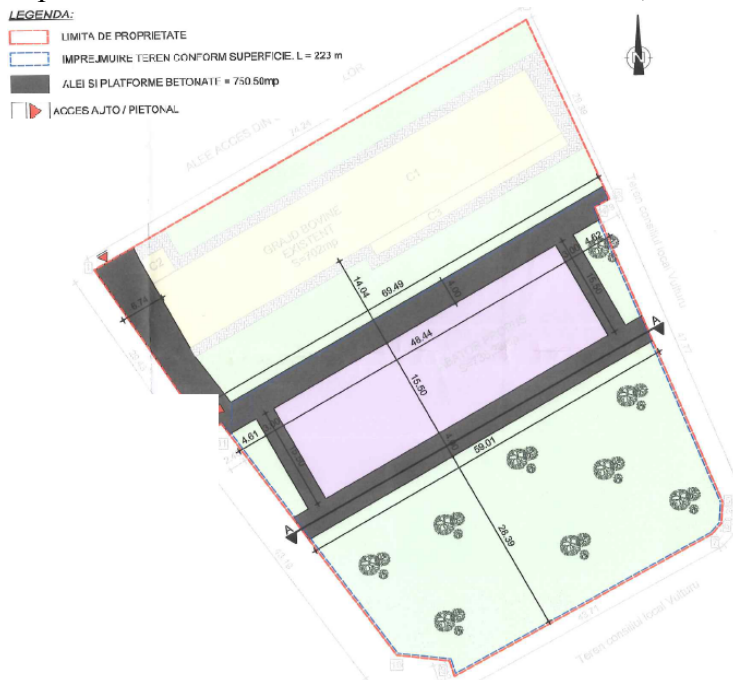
Accesul pe amplasament (extras Plan de situatie si detalii alei/platforme betonate si imprejurimi)
